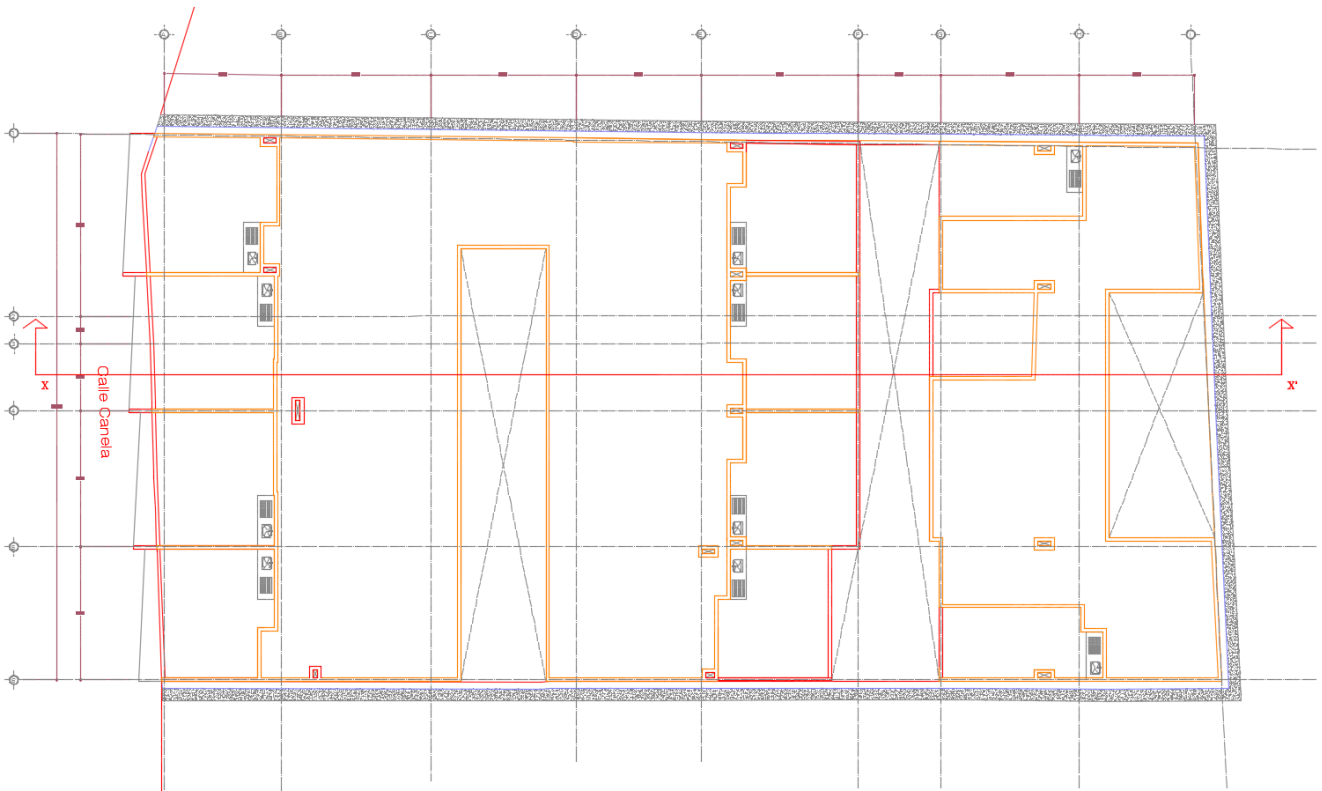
PLANTA ARQUITECTÓNICA TECHOS
